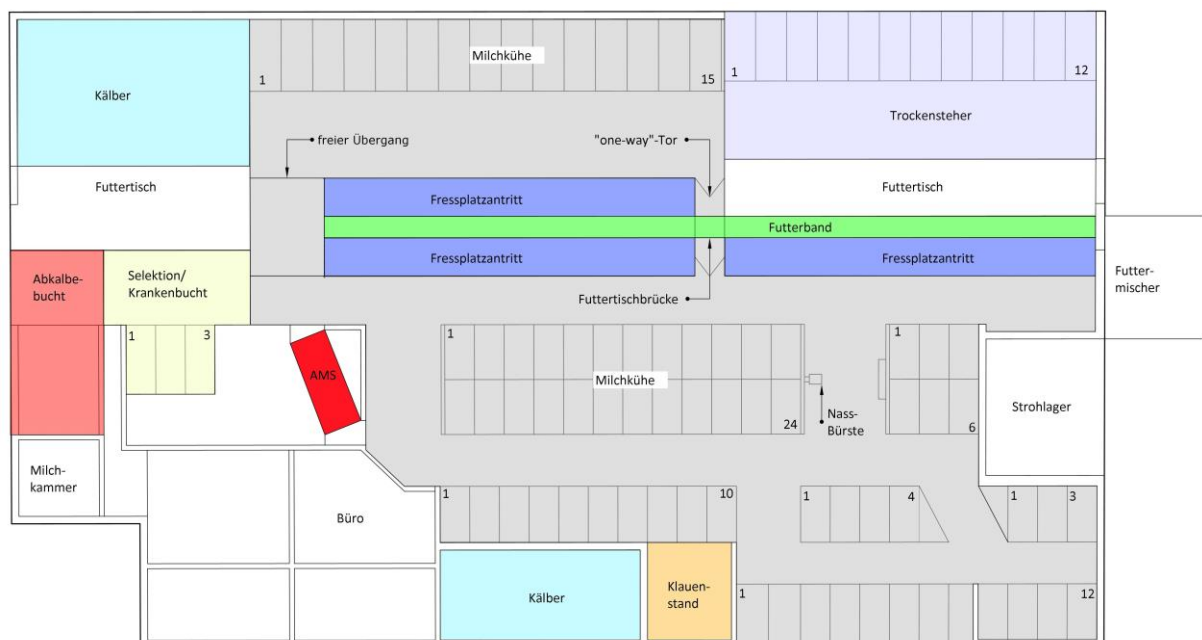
Gebäudegrundriss und Raumprogramm nach den Umbaumaßnahmen
